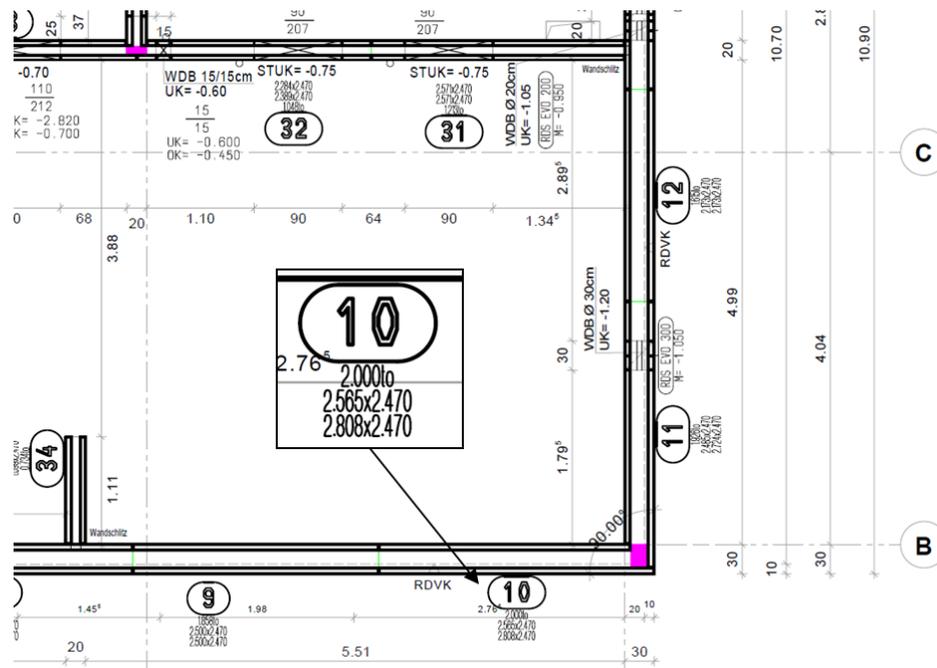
Auszug aus einem Schalungsplan - EW (Grundriss) [ZTK16]
